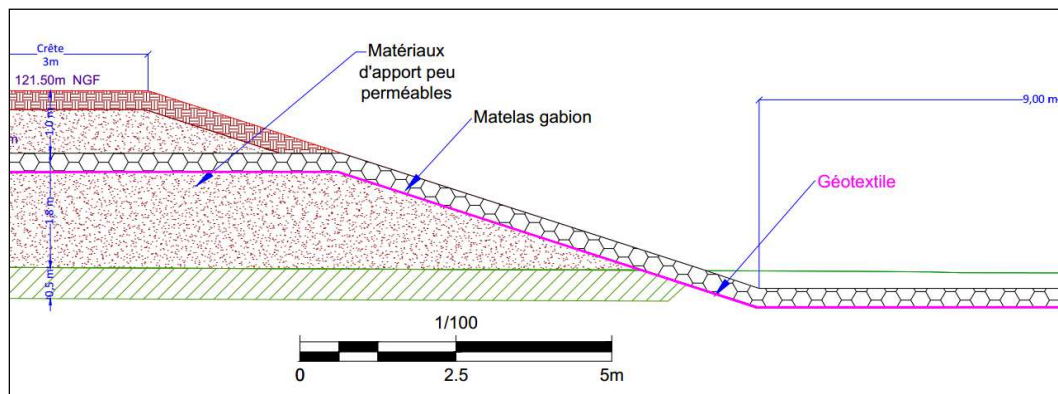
Ouvrage D19-8 - Coupe en travers du corps de l'ouvrage (parement aval)
